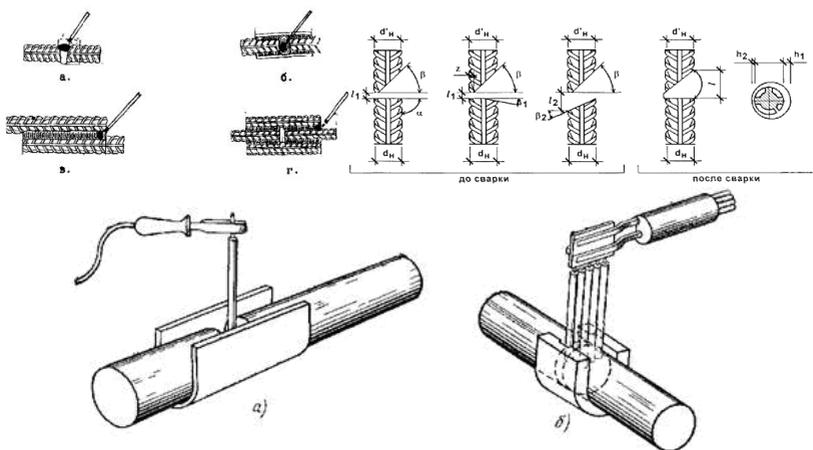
Виды сварки арматуры железобетонных изделий: *а* — сварка одним электродом на остающейся подкладке; *б* — сварка несколькими электродами на съёмной подкладке
